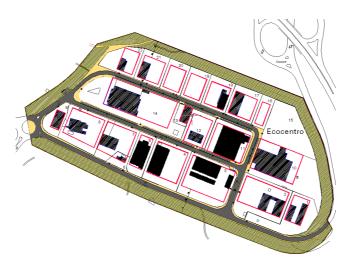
Planta de implantação do Plano de Pormenor da Zona lindustrial de Fornos de Algodres
